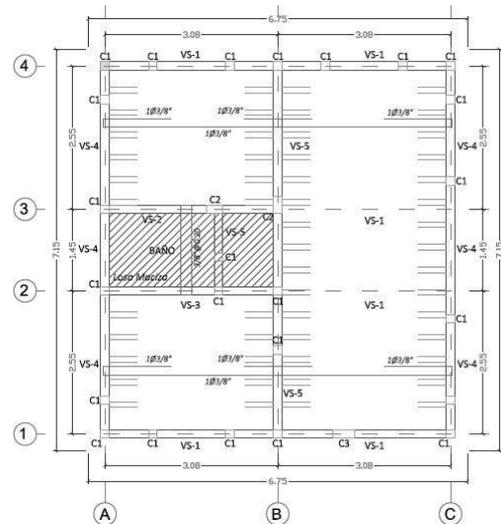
Detalle del techo aligerado VUF 04 - AC.
